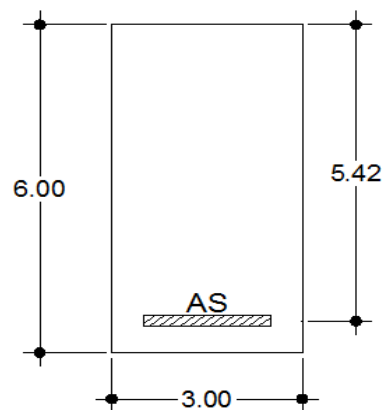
Detail Tulangan Tumpuan Sloof Memanjang
